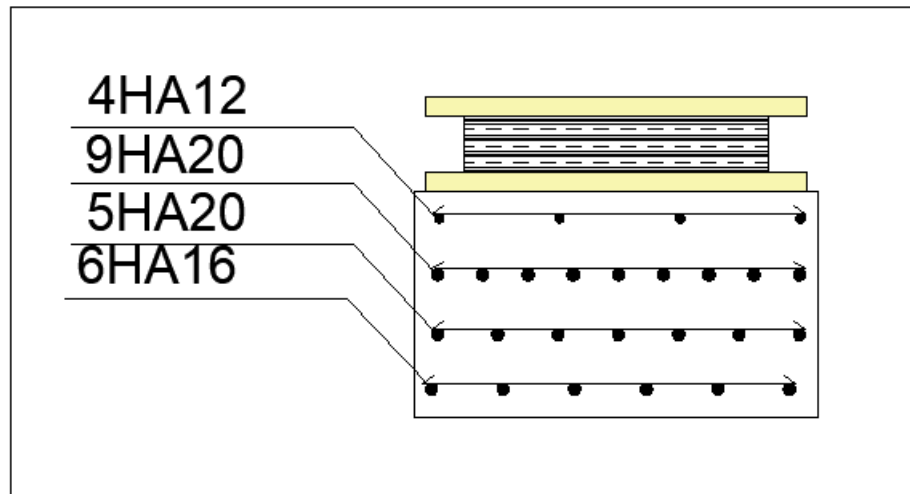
Ferrailage de de d'appuis au niveau de culée.
